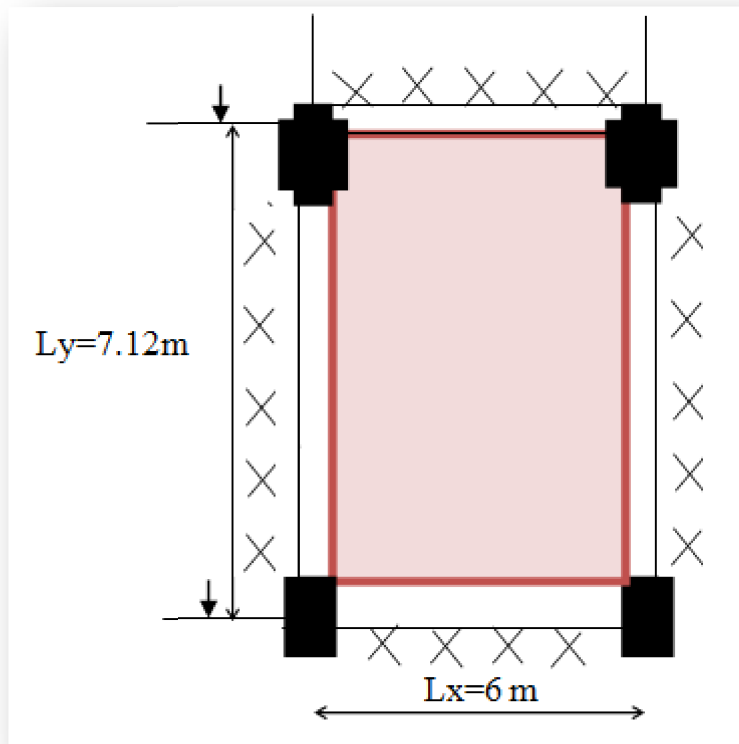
Dimensions de la dalle inclinée du gradin.
